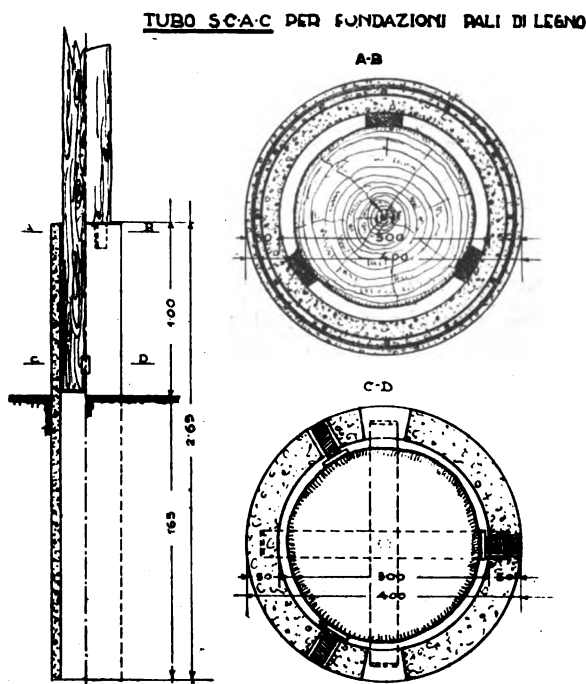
Fondazione sostegno tubolare per pali di legno.
